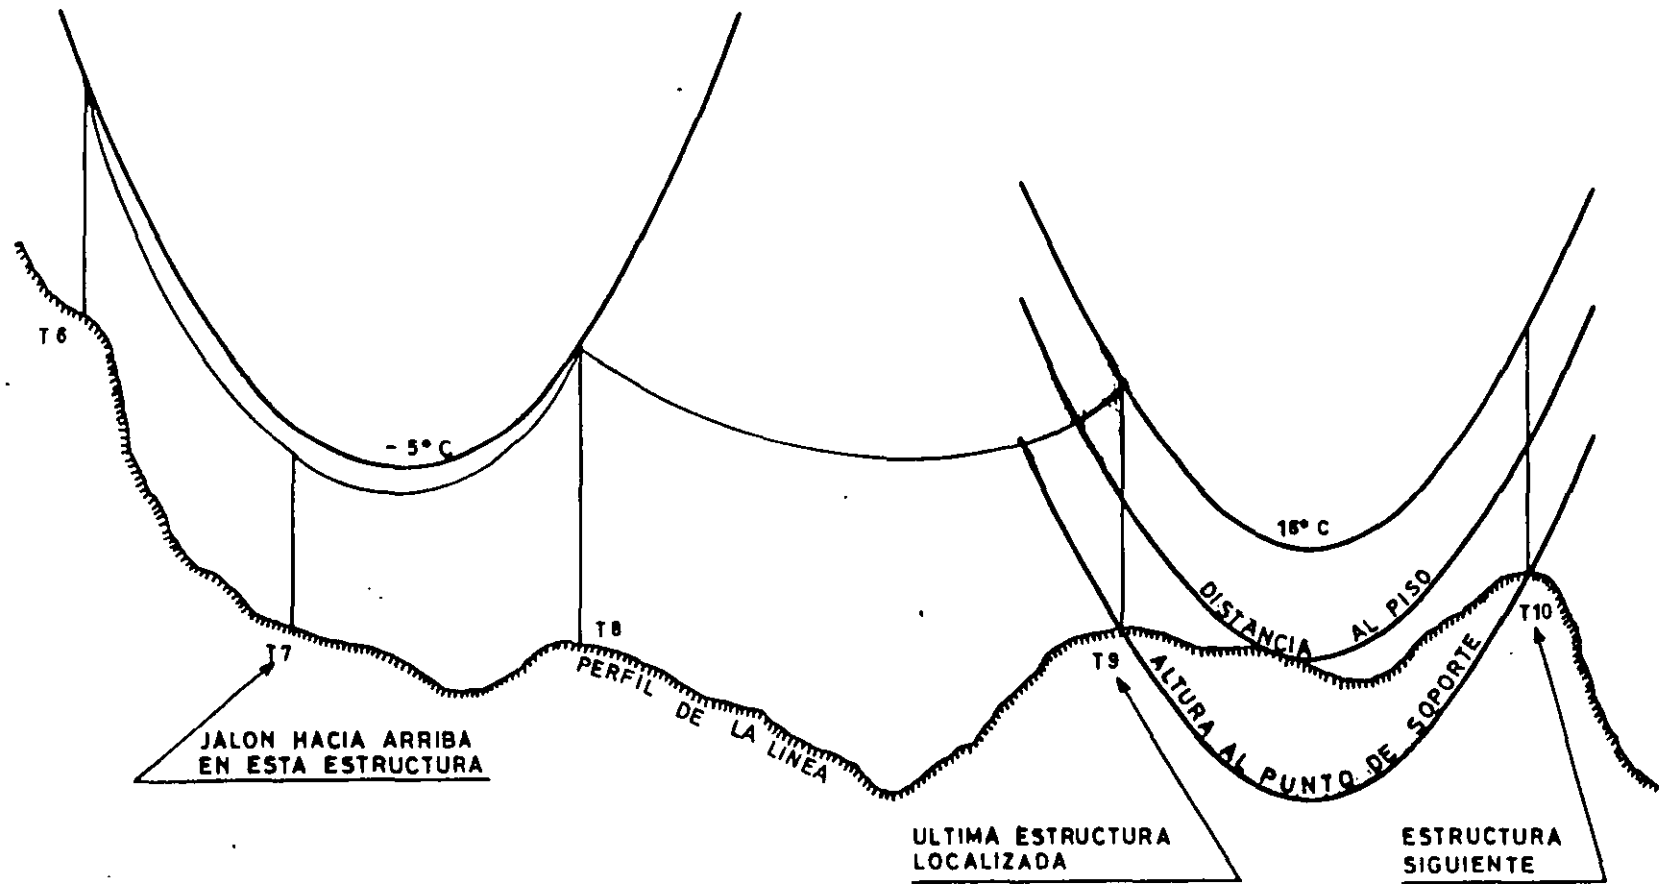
LOCALIZACION DE ESTRUCTURAS POR MEDIO DE UNA PLANTILLA
